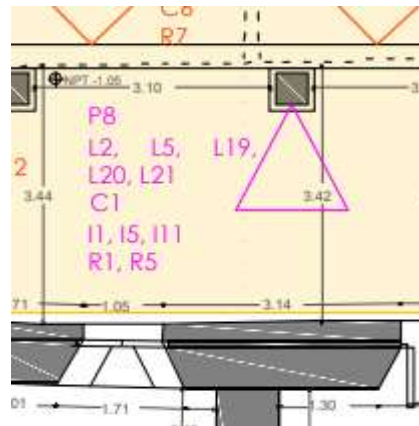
Sección del plano de Restauración, elaboración propia.
